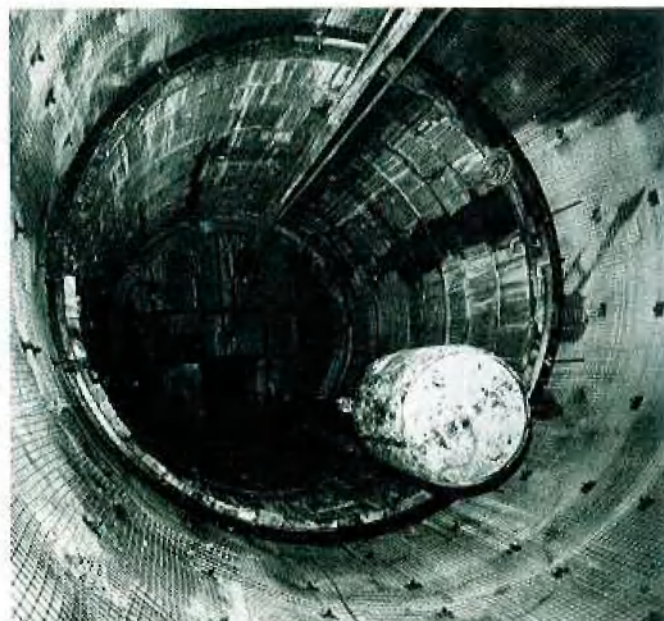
Blick in den gebohrten Schachtteil vom oberen Maschinendeck aus. unten: vorläufiger Ausbau mit Sprezhülsenankern und Maschendraht oben: endgültiger Ausbau mit Glasfibrerpaneelen und Betonhinterfüllung
